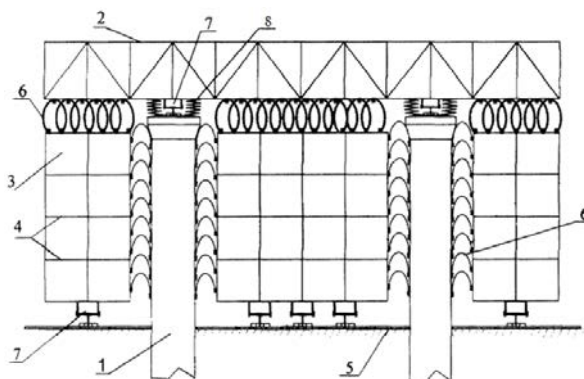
Сейсмостойкое здание подвесного типа: 1 – опорный ствол; 2 – двухконсольная ферма; 3 – подвесная часть; 4 – перекрытия; 5 – фундамент; 6 – упругие элементы; 7 – корректоры жёсткости; 8 – сейсмоизоляционное устройство
